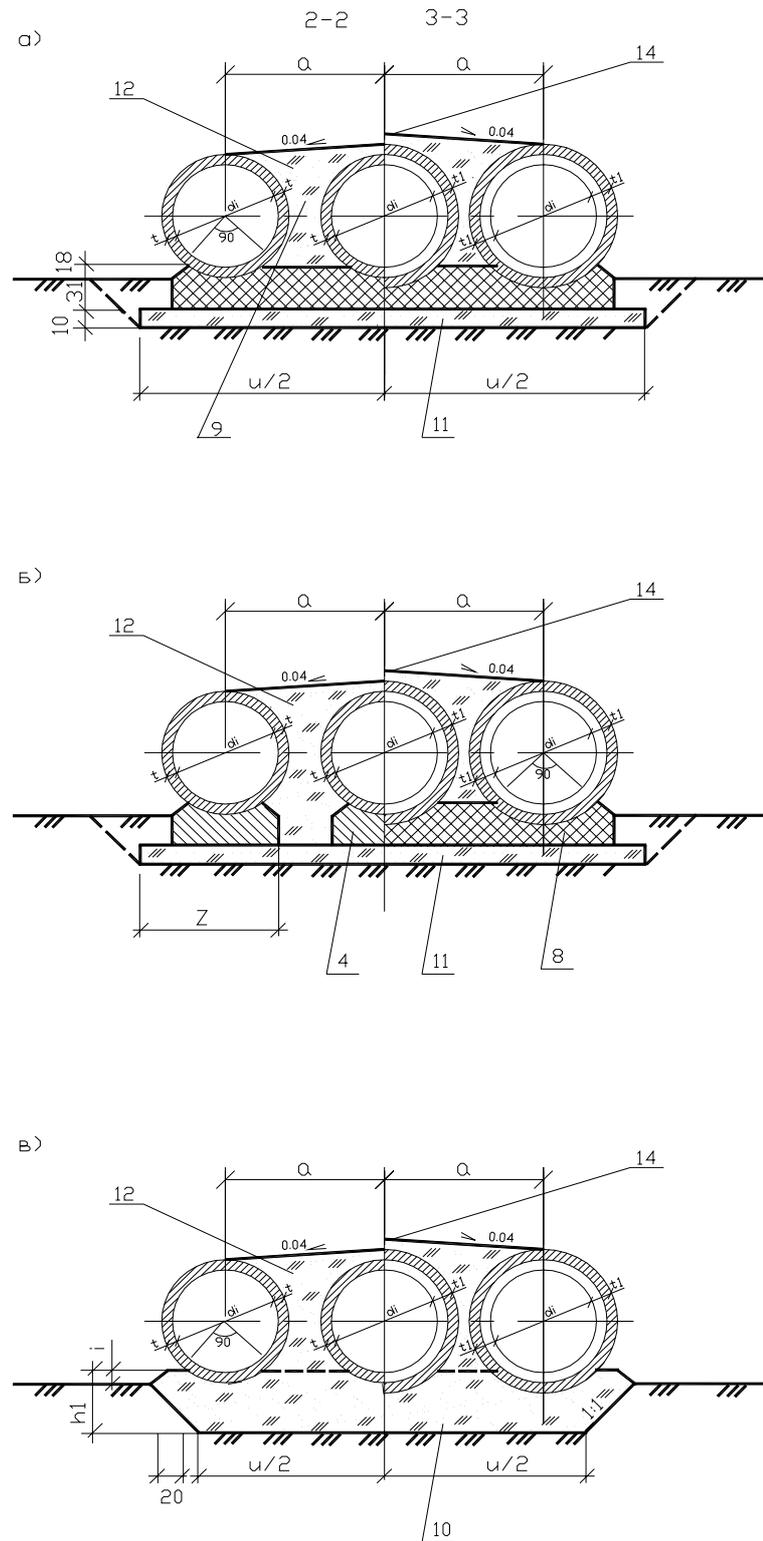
Поперечные сечения 2-2 и 3-3 (см. рис. 8.2) трехочковые трубы на монолитном (а); сборном (б) фундаментах и на подушке из гравийно—песчаной смеси ( в ): 9 - бетон В20; 4 - фундаментные блоки; 11 - подготовка из щебня или гравия; 12 - заполнение пазух бетоном В7.5; 14 - гидроизоляция обмазочная
